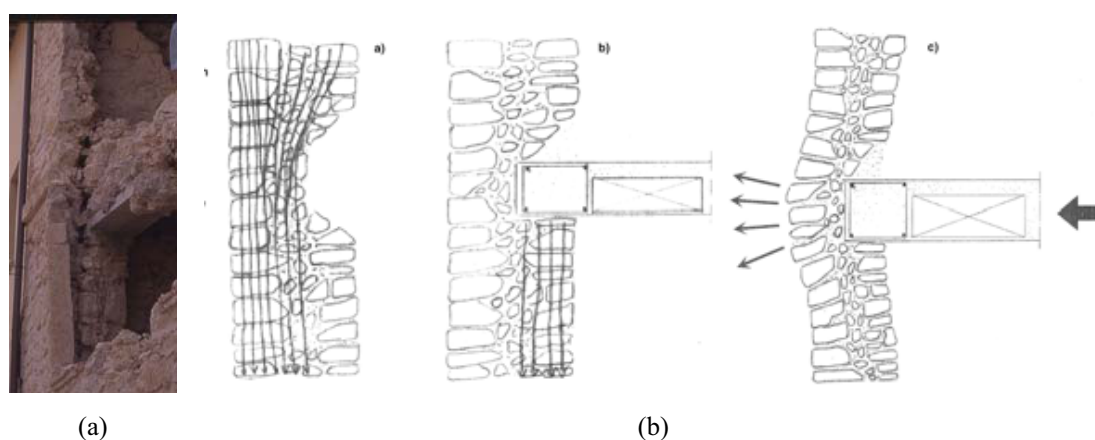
Efeito do reforço com vigas de betão armado no comportamento de estruturas de alvenaria com paredes de panos múltiplos (Binda, 2006): (a) efeito da excentricidade das cargas verticais; (b) efeito do impulso de pavimento de betão armado nas paredes.
